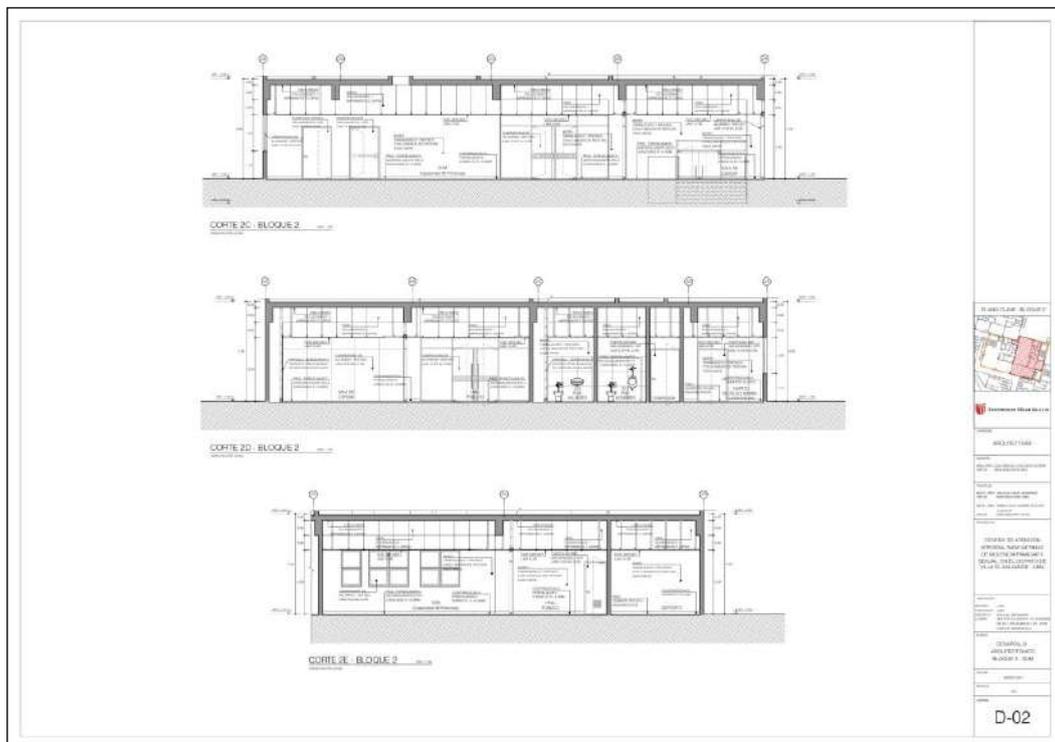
Cortes primer nivel de zona SUM – bloque 2.
